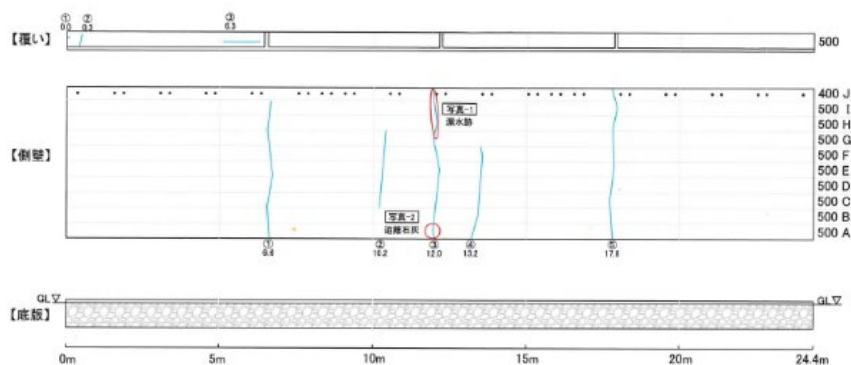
ひび割れ観察例（1号 6-A 北面展開図）
